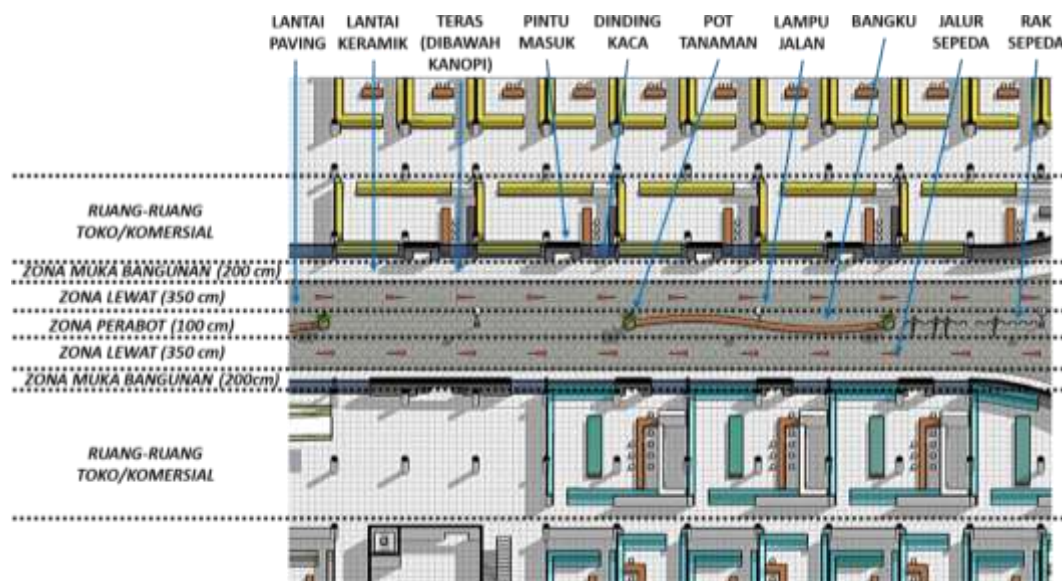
Detail Susunan Bangunan dan Ruang Dalam
